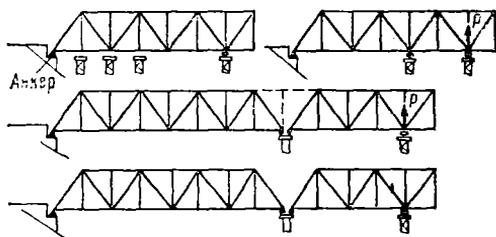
Виды опирания пролетных строений на вспомогательные опоры при полунавесной сборке
